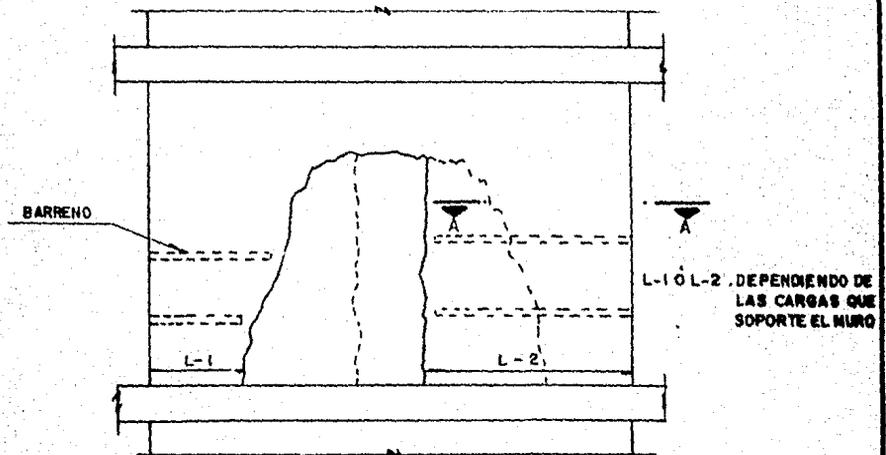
CORTE DE REFUERZO PARA PODER BARRENAR
